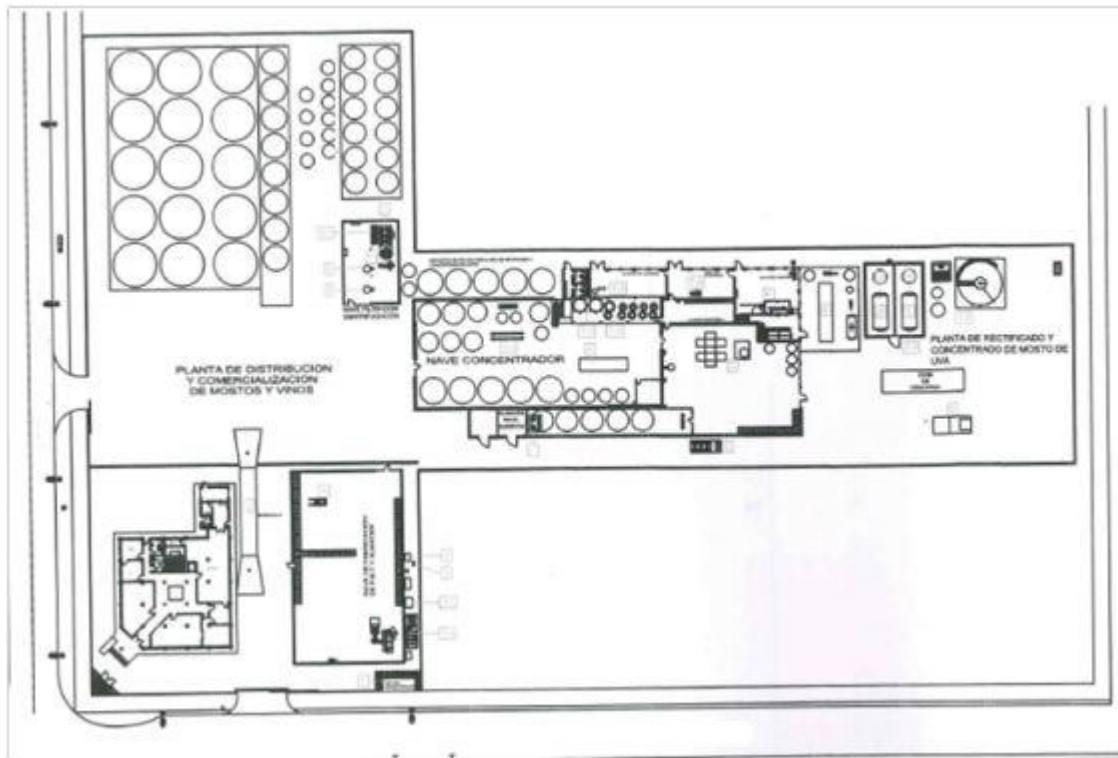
Plano de vista en planta de las instalaciones. Fuente: Empresa auditada
